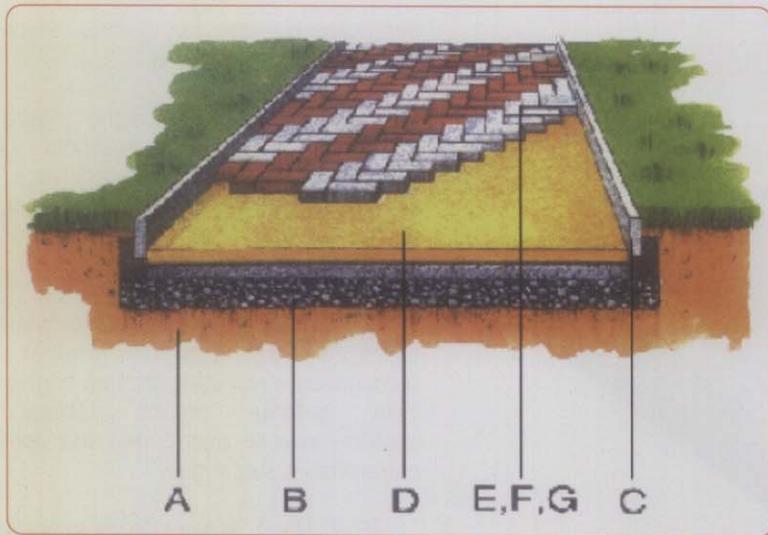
Proceso Constructivo de un Pavimento Intertrabado
